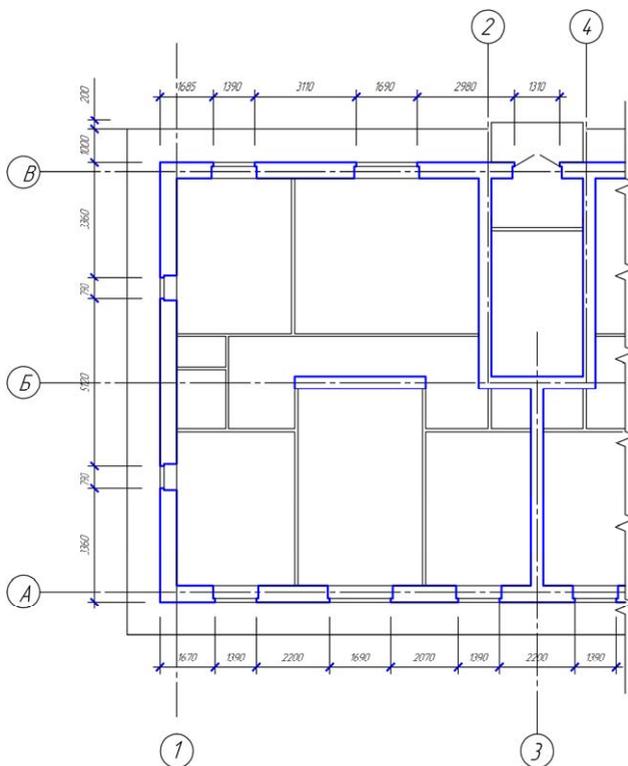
Изображение проемов окон и дверных проемов на наружной капитальной стене
